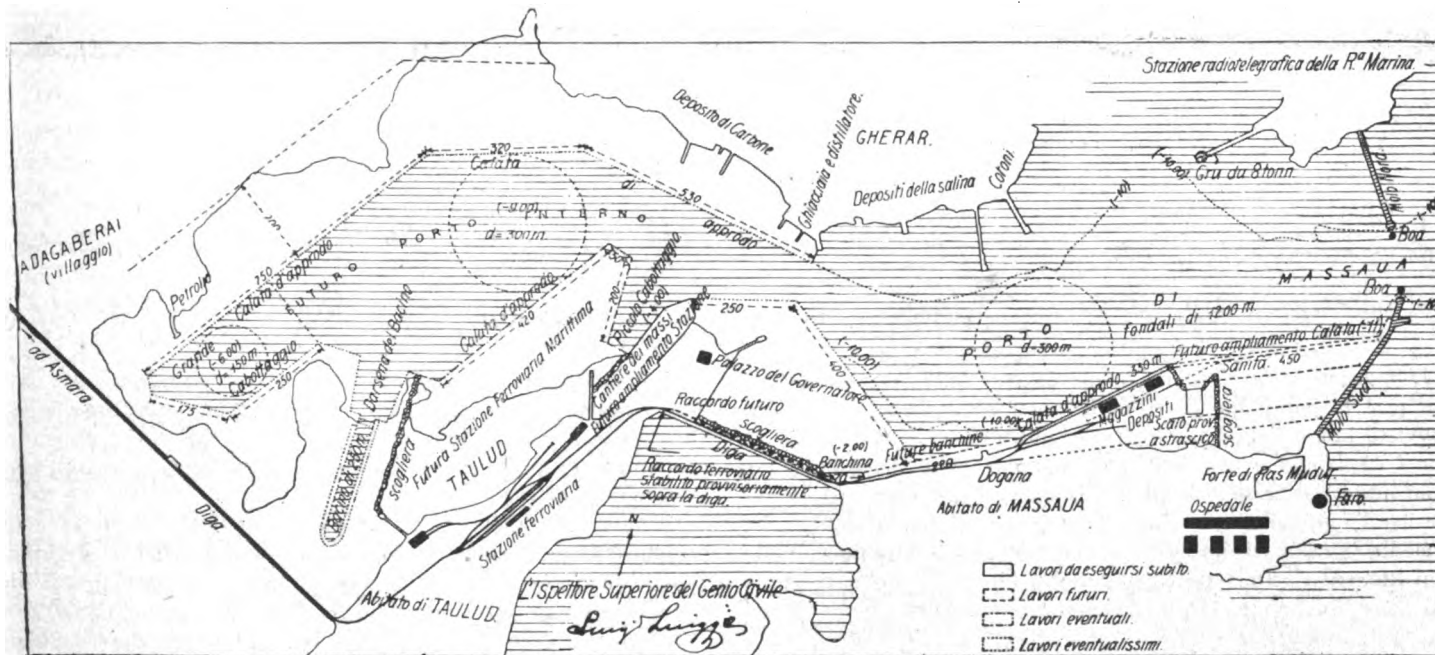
Porto di Massaua. - Planimetria generale. (Ing. Prof. Gr. Off. LUIGI LUIGI).
